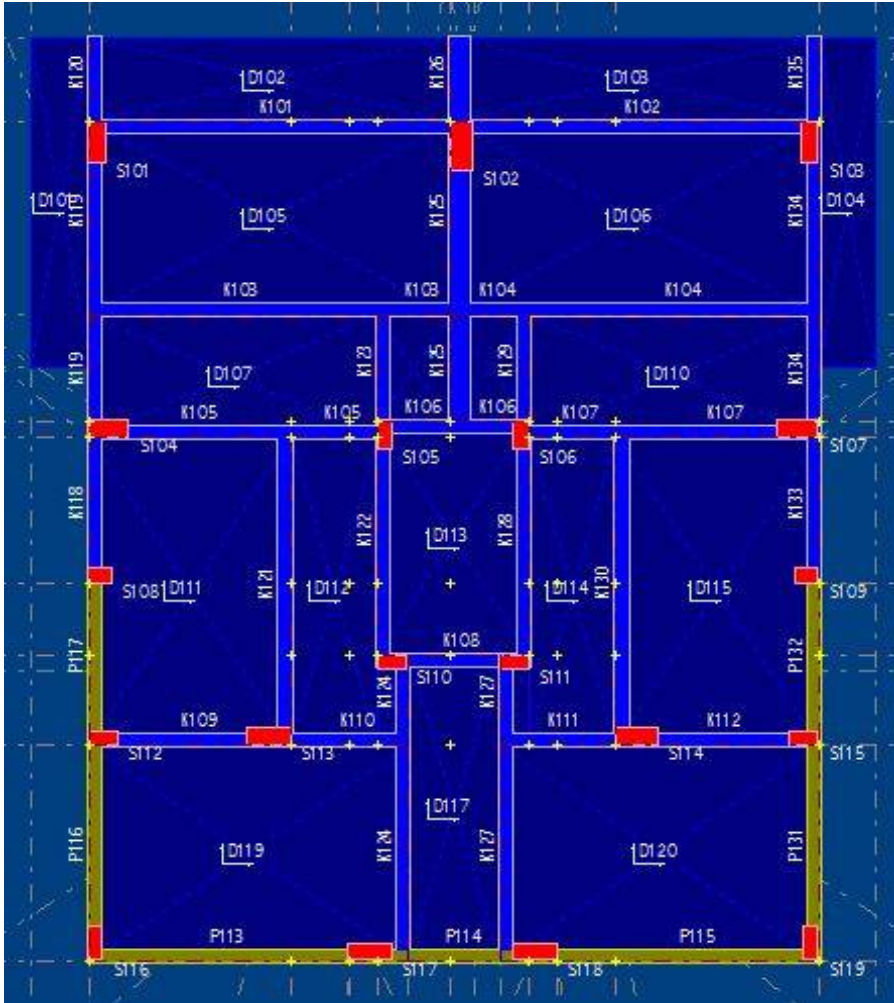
(1) Nolu bina modelleme kat planı
